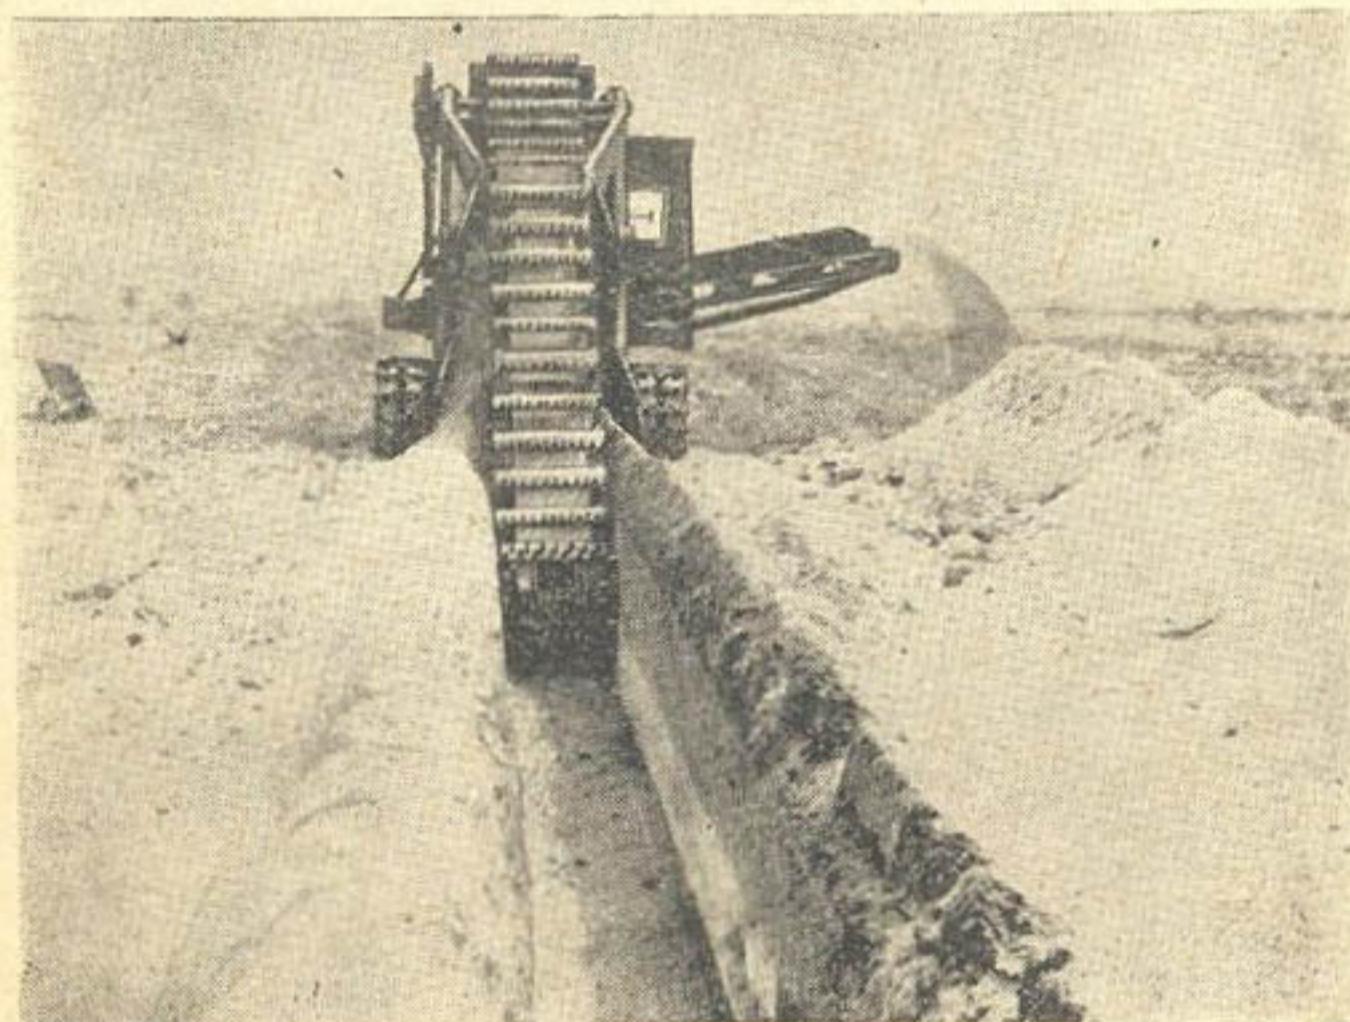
Рытье траншей для трубопровода закрытой оросительной сети многоковшовым экскаватором.
